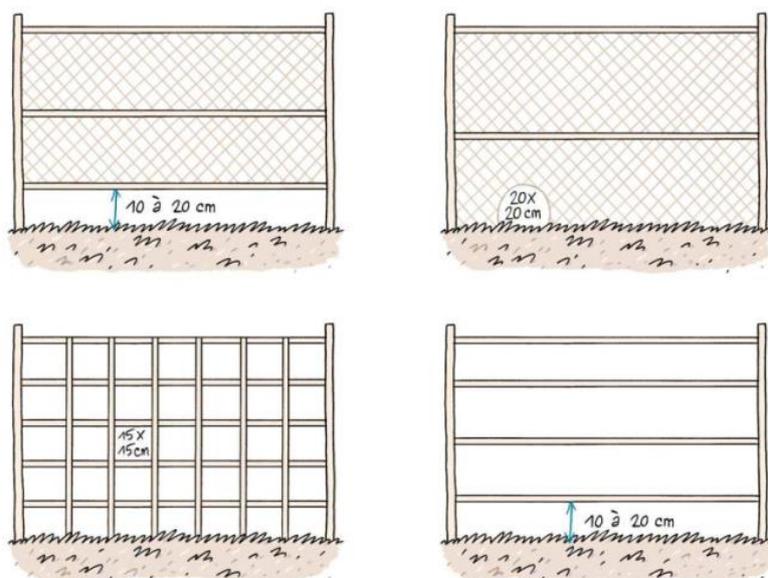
Exemples de clôtures facilitant la circulation de la petite faune (Source : Bruxelles Environnement)
